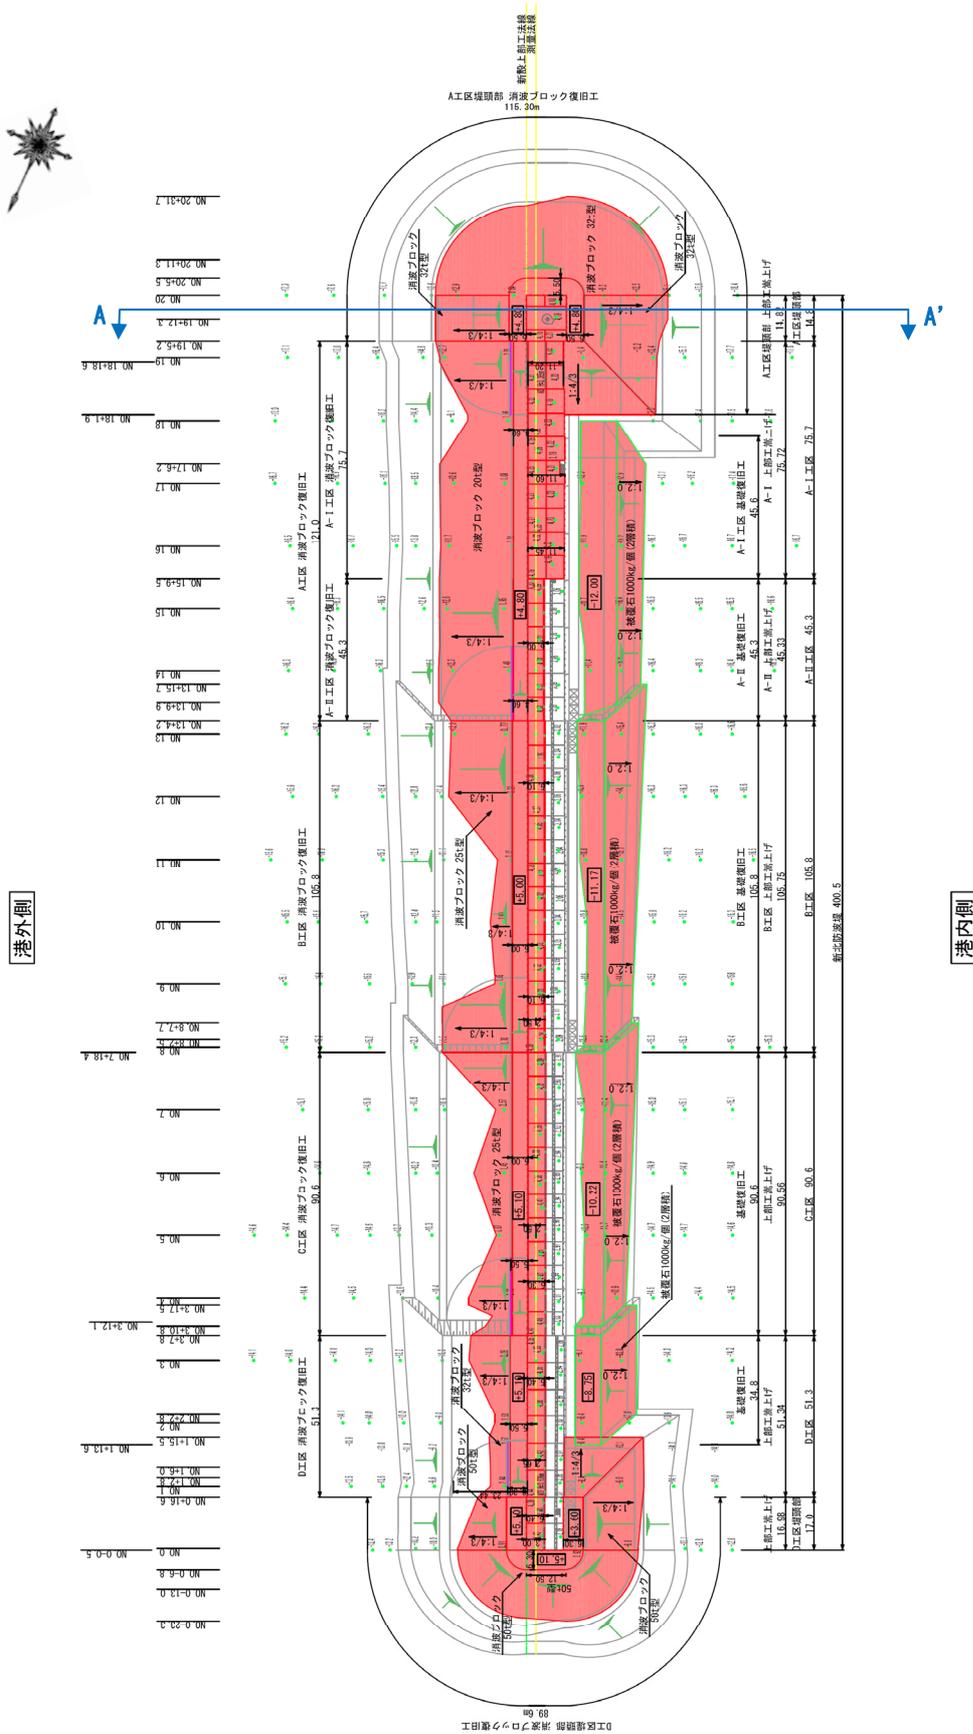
仙台港区\_新北防波堤の平面図(復旧後)
